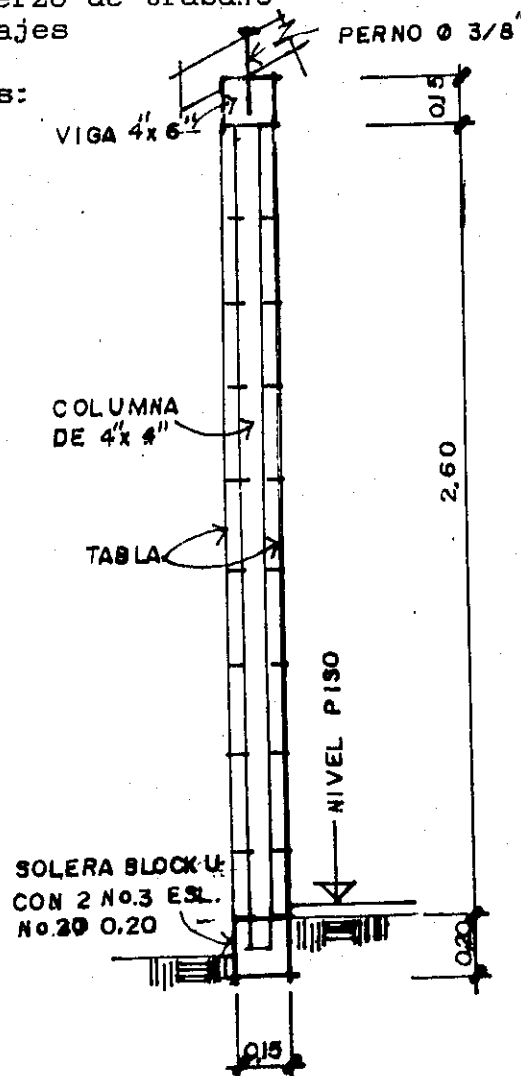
DET. MURO MADERA ESCALA 1:20
